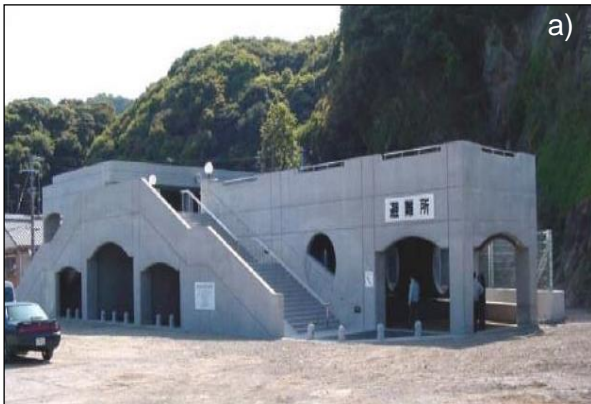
Refugios de concreto reforzado en Prefectura de Tokushima, Japón (FEMA, 2008).
